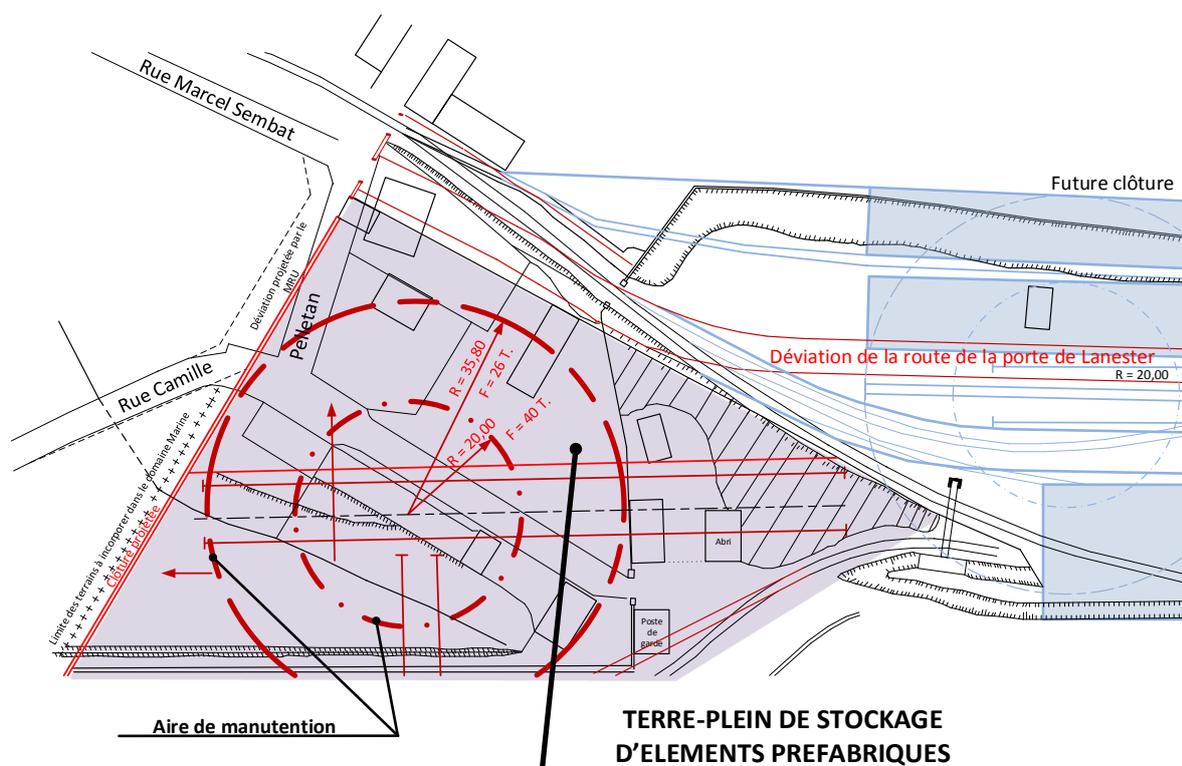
Terre-plein de stockage A1, extrait du plan de masse
